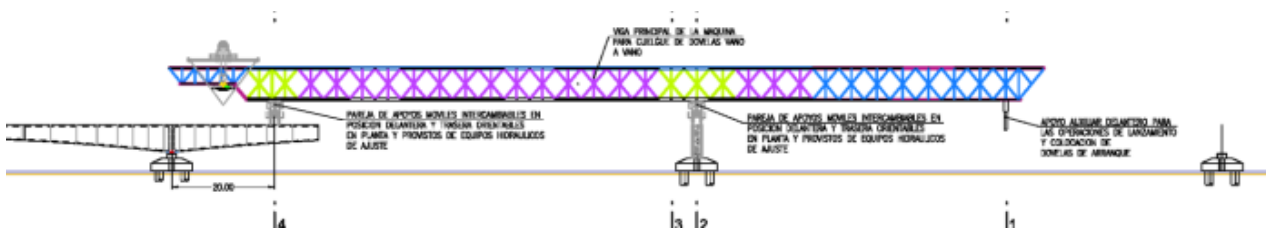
Alzado viga de lanzamiento para vanos de 100 m
